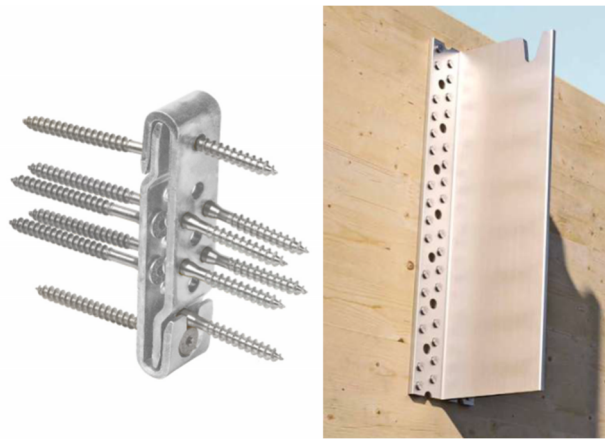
Assemblage poutre-poutre de type « dovetail » (à gauche) et étrier Alumidi de Rothoblaas (à droite)
